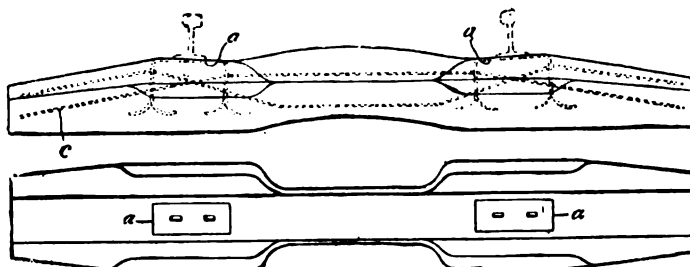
Traversa Hintermann. - Sezione e pianta.
